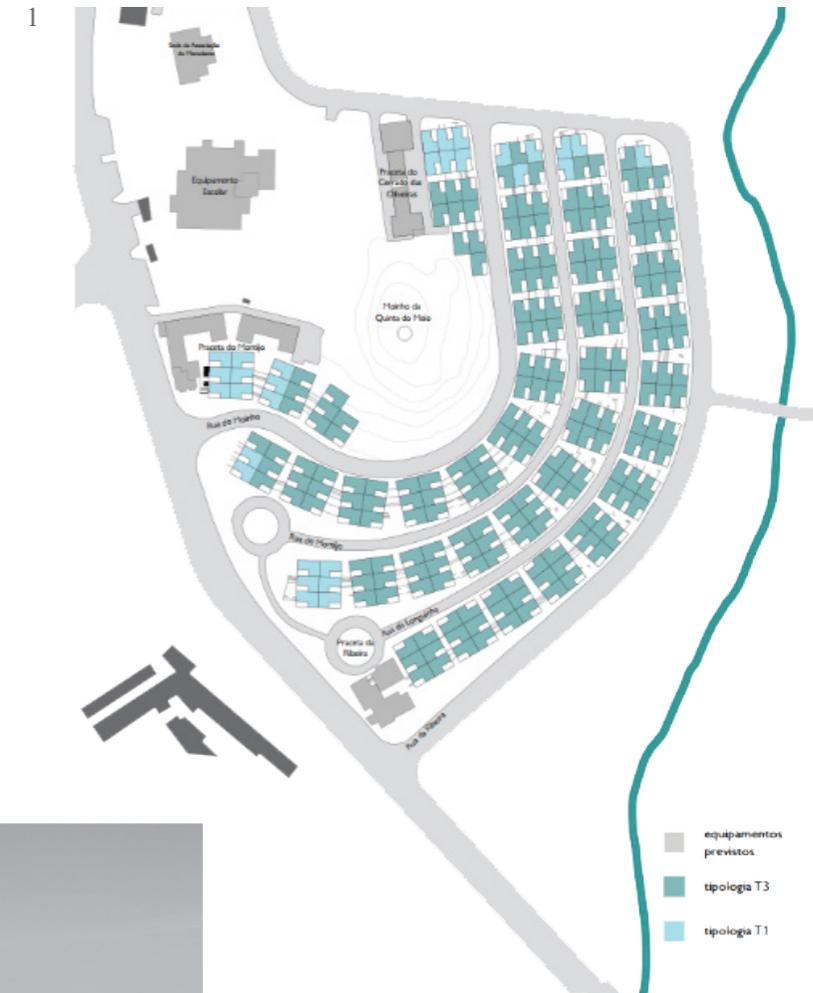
Planta do Bairro Alto do Moinho, 1976.
